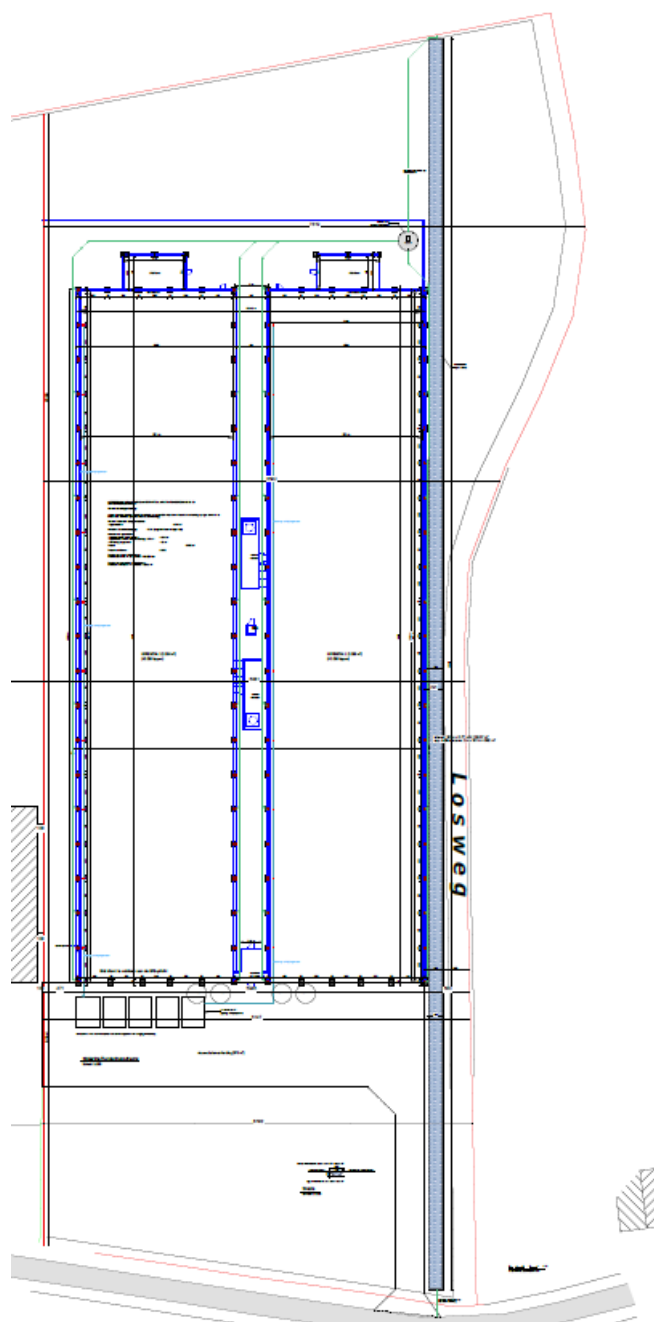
Inplantingsplan van de geplande verkaveling⁶
